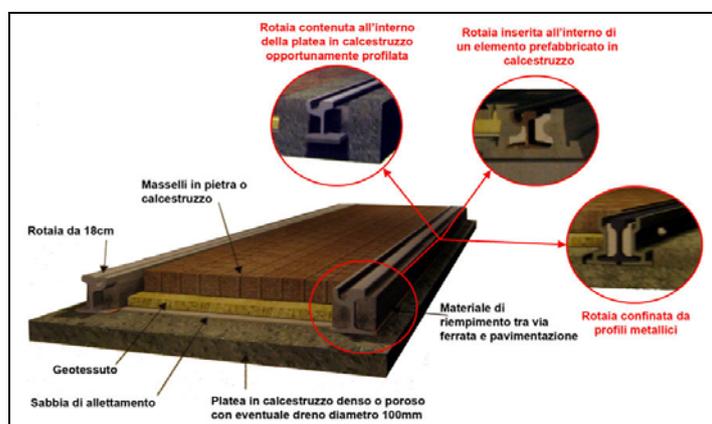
Schema di soluzione modulare con appoggio continuo [1]
